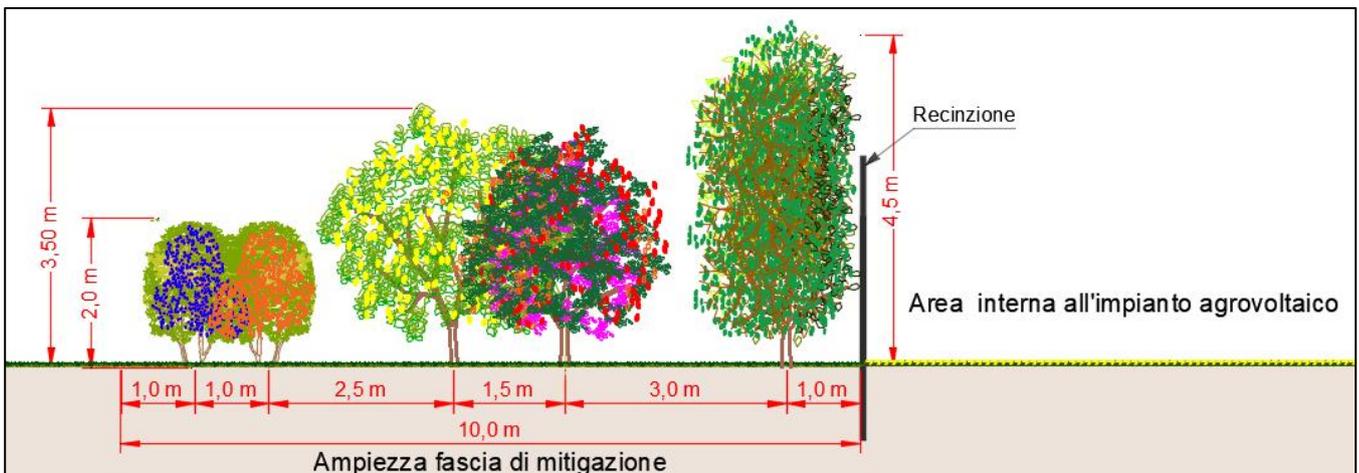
Rappresentazione della fascia perimetrale di mitigazione visiva: Area della biodiversità (10 metri) - vista in sezione
